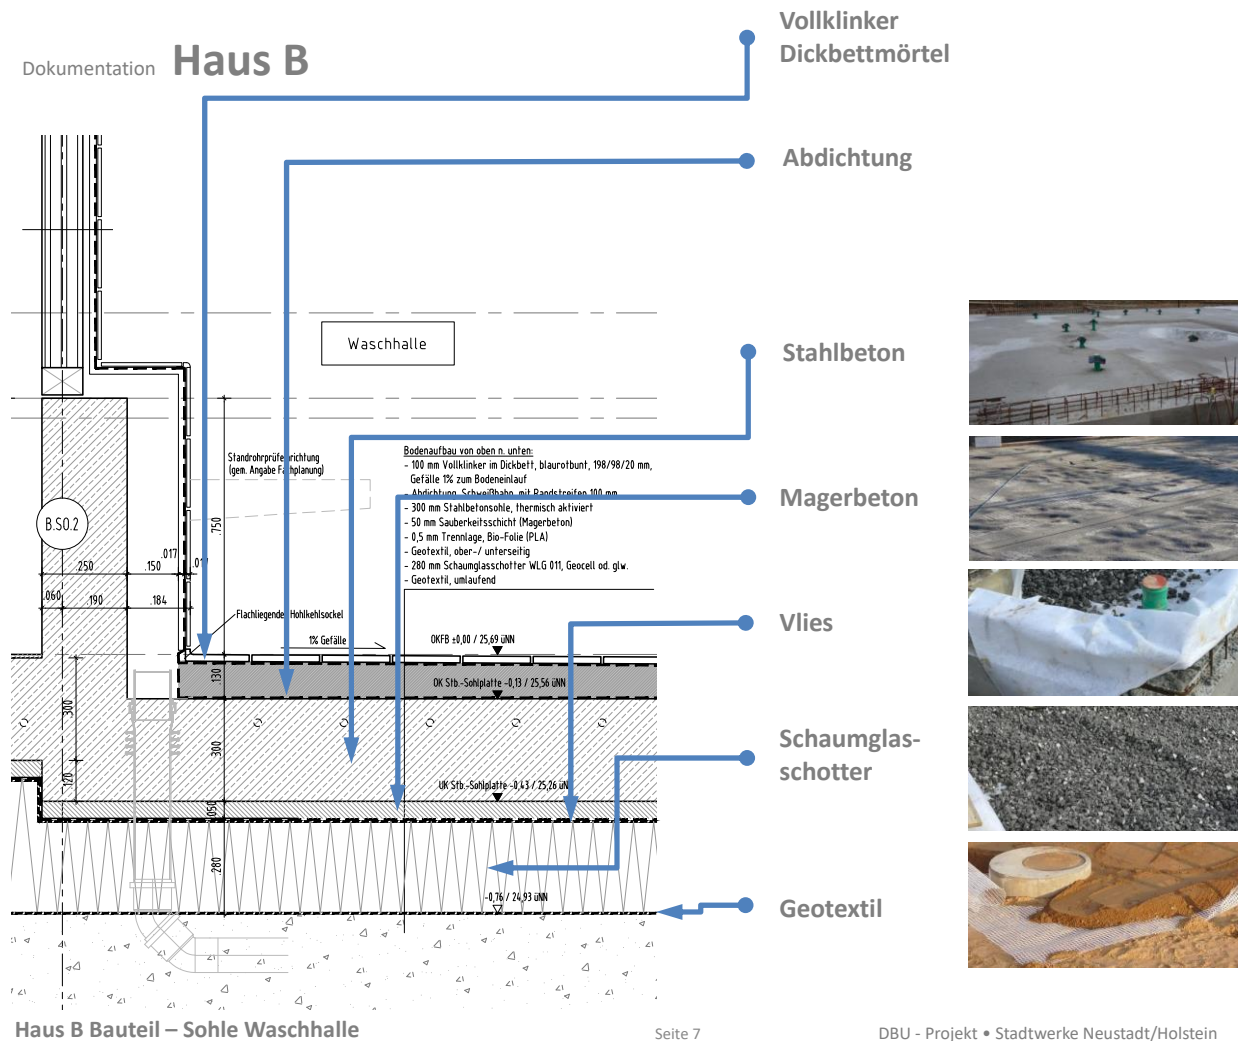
Detail Sohle Haus B – Bereich B - Waschhalle
